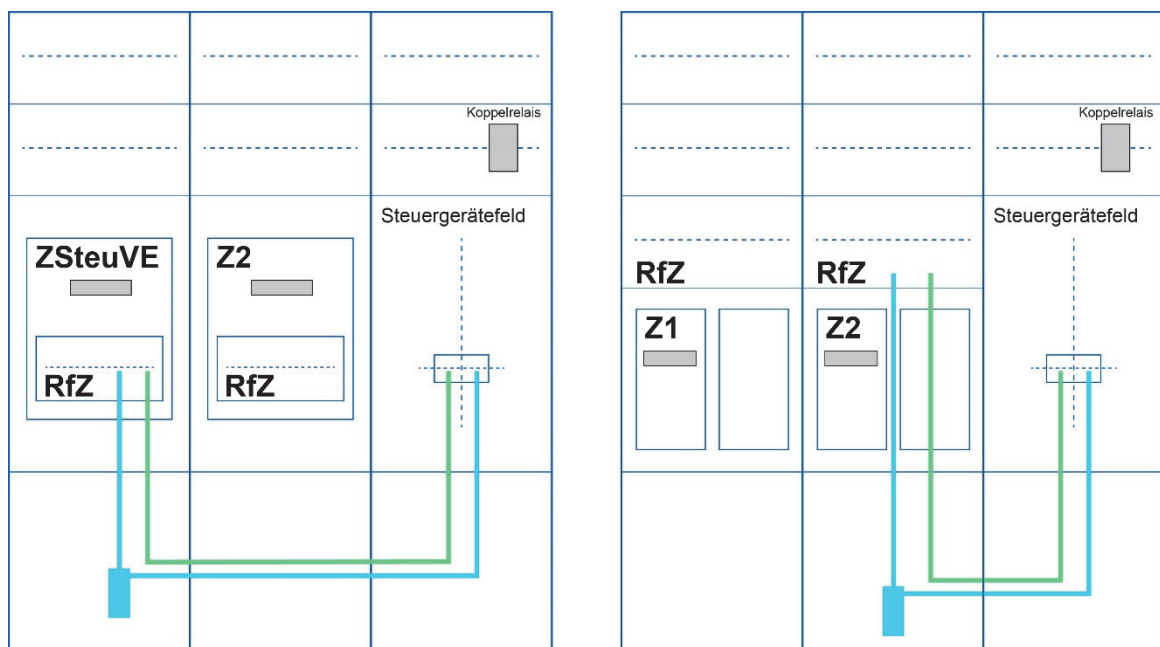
Bestandszählerplatz mit einem Steuergerätefeld
